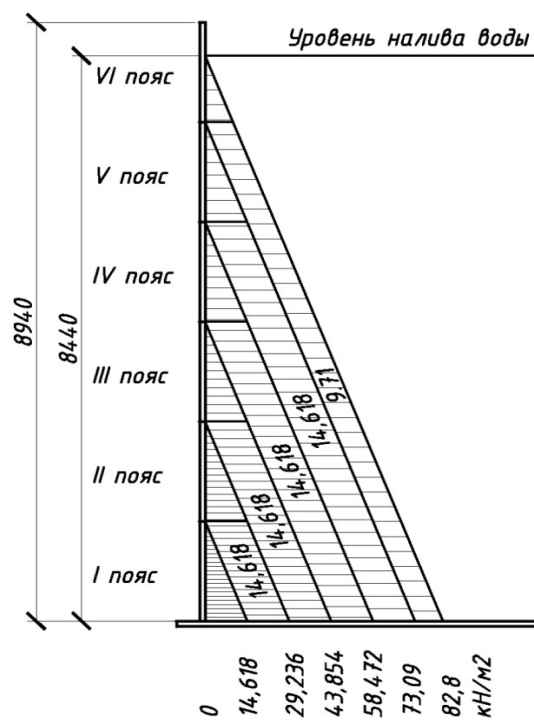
Схема поэтапного нагружения резервуара гидростатической нагрузкой в нелинейной постановке.
